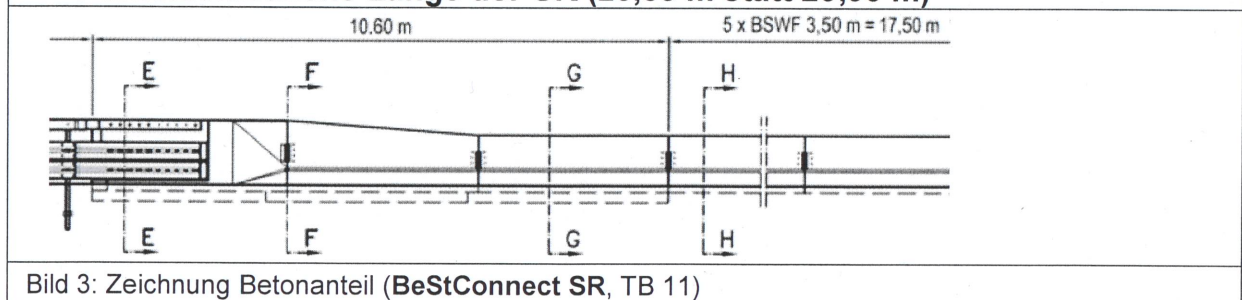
Zeichnung Betonanteil (BeStConnect SR, TB 11)
